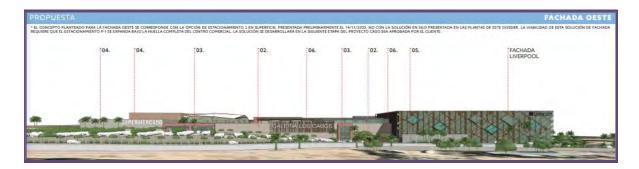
Se muestran las fachadas principales del proyecto Centro Comercial Galerías, Los Cabos sin escala.
